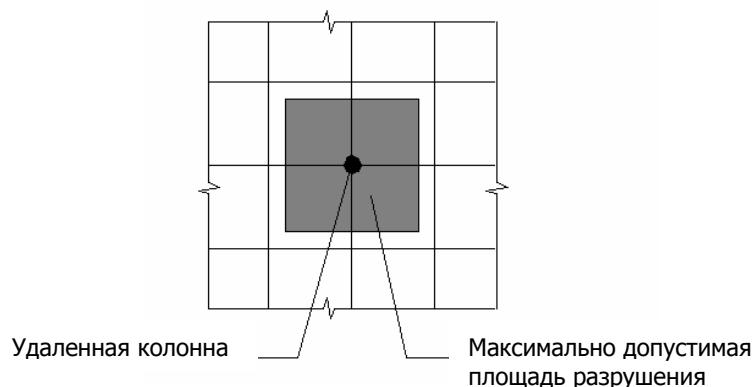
Схема предельно допустимого разрушения плиты перекрытия в средних пролетах
